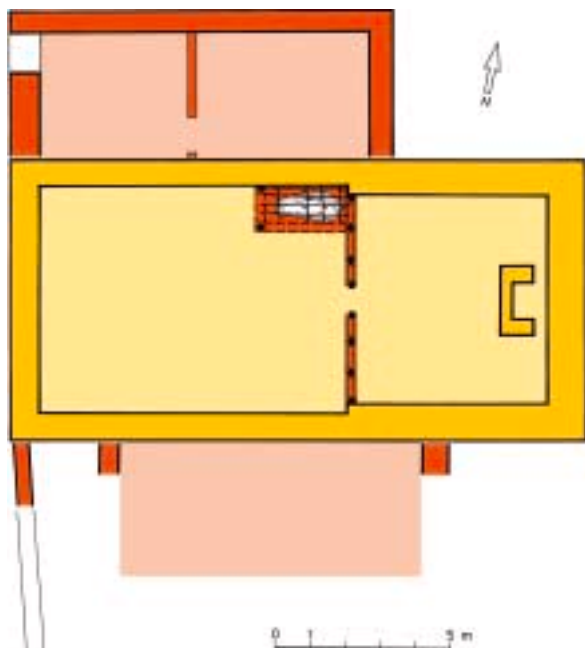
Grundriss der Kapelle von 1290 (gelb) mit sekundären An- und Umbauten (rot).
